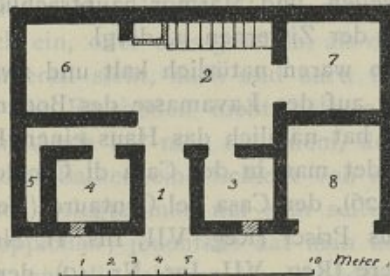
Grundriss eines kleinen Hauses.
